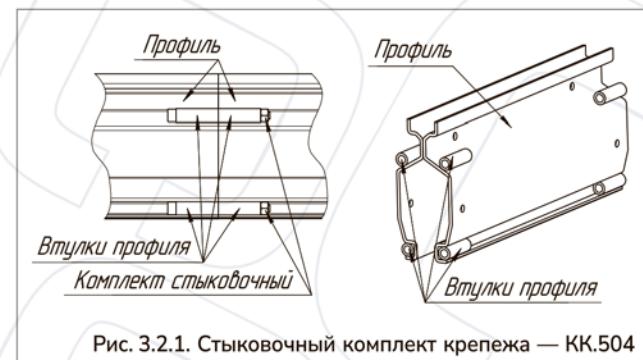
Стыковочный комплект крепежа — KK.504
